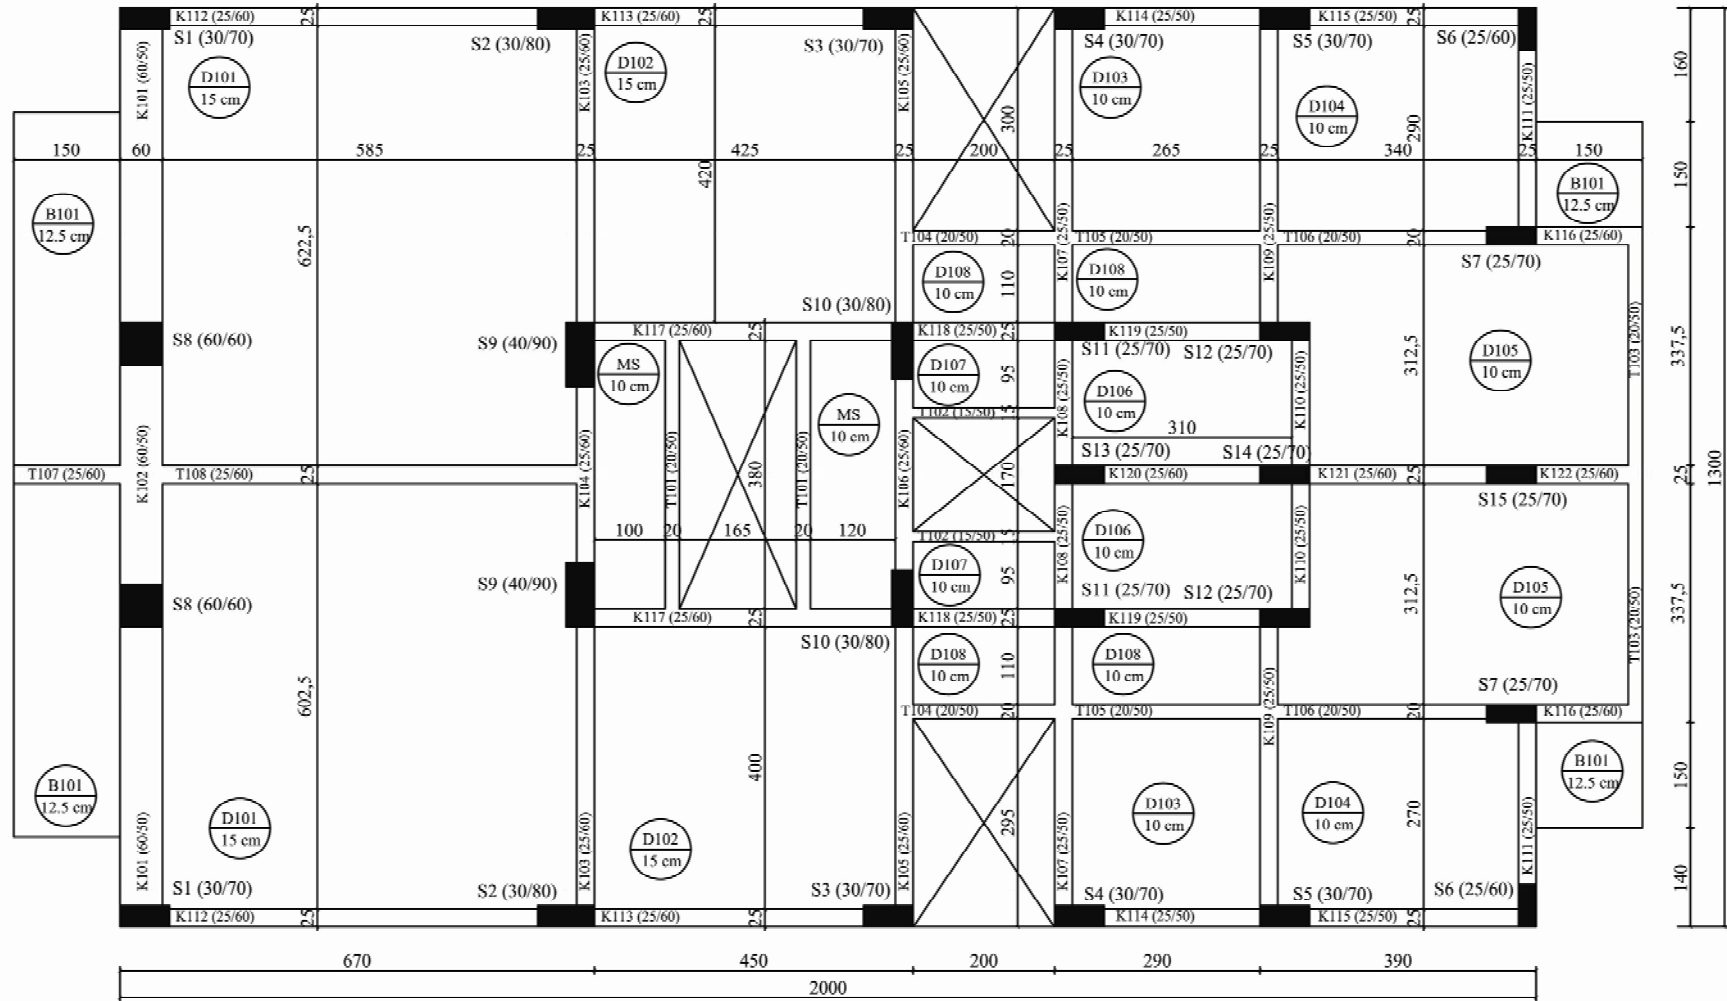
B8\_2'nin kat kalıp planı
